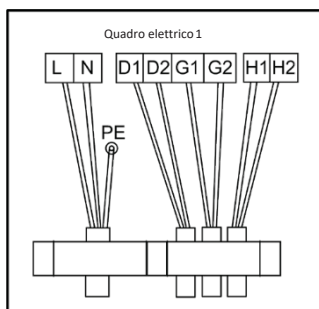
Cablaggio esterno e schema di fissaggio
